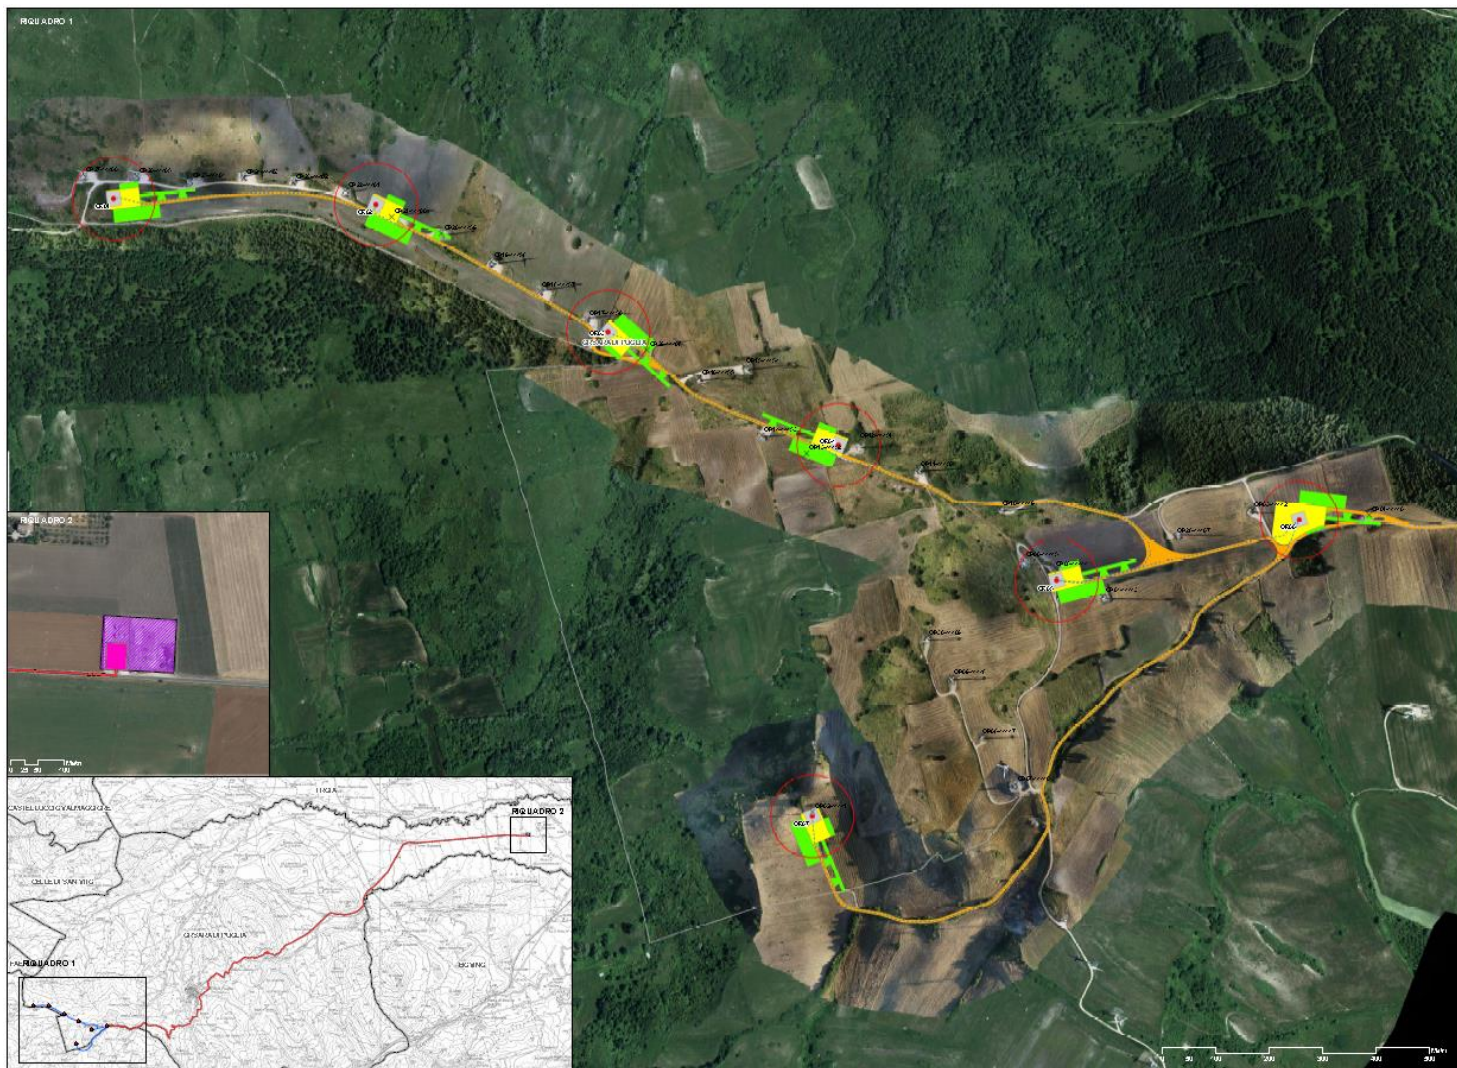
Ortofoto drone (Settembre 2023): Planimetria generale - VIA_02_WJQUTJ3-ORTO
